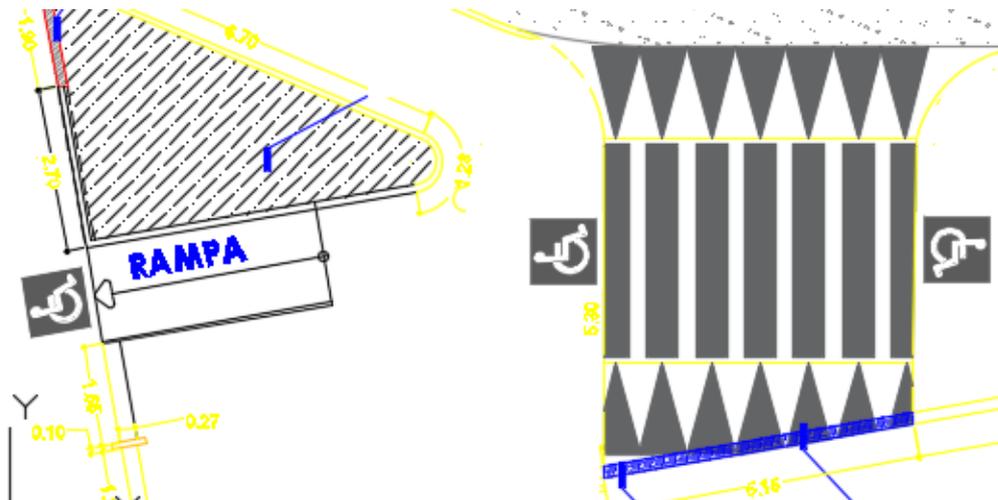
Detalhamento da faixa de pedestre e da rampa de acesso com a sinalização.
